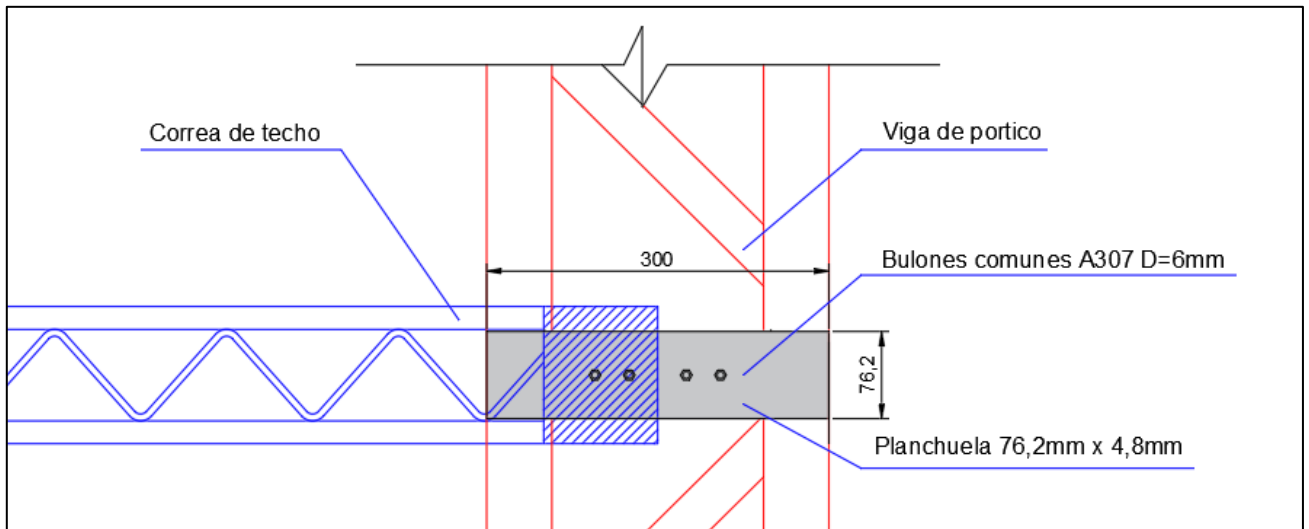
Detalle unión correa de techo - viga de pórtico
